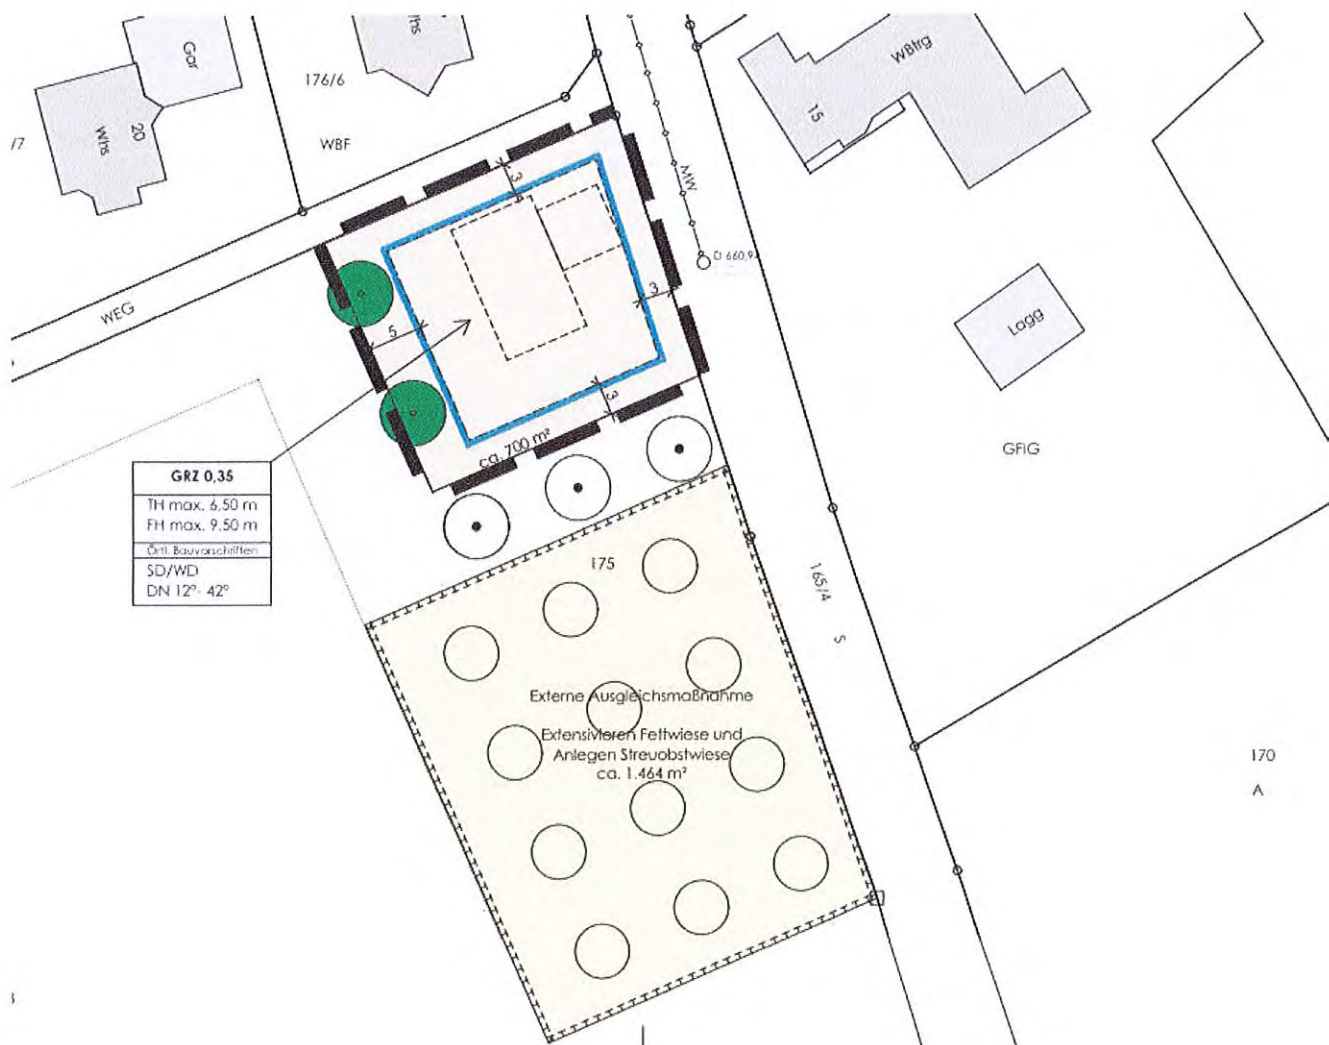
Planteil „Waldergasse Flst. Nr. 175 Teilfläche“ (Kasten Architekten)
